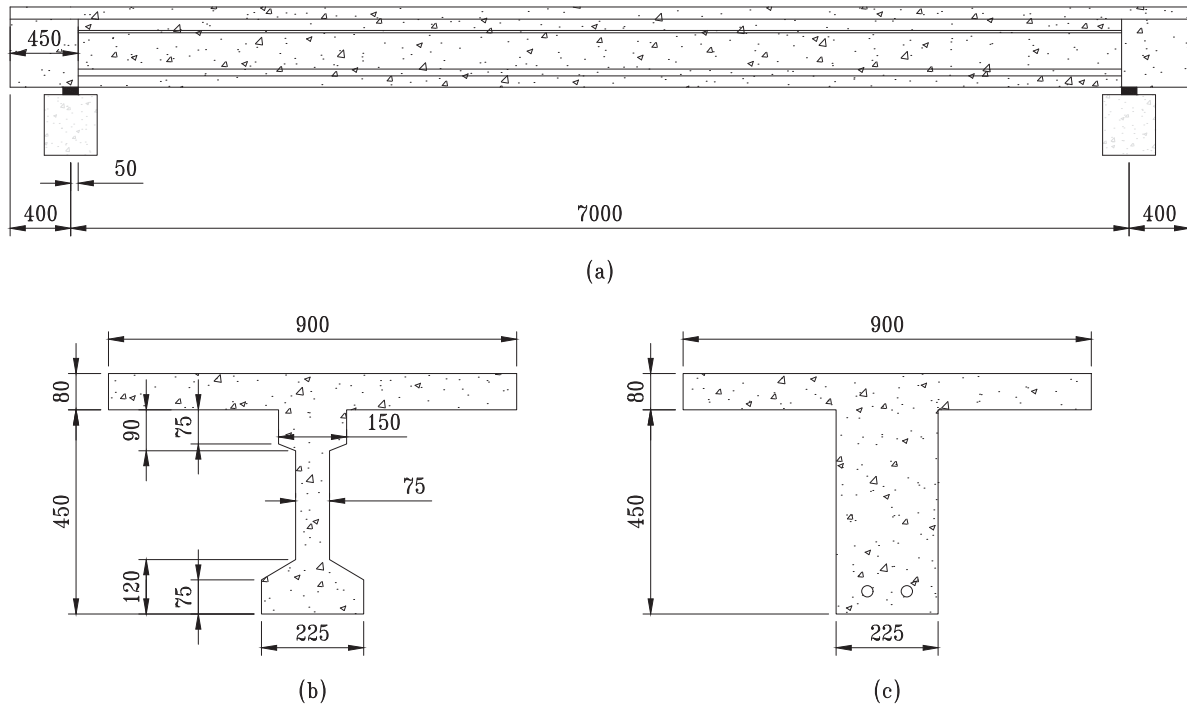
Géométrie des poutres : (a) vue en élévation, (b) section en portée et (c) section aux appuis
